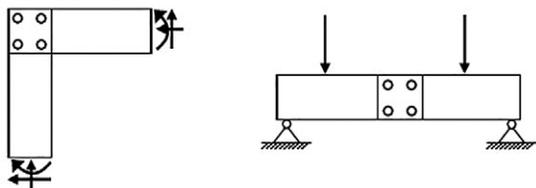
Схема приложения нагрузки при испытании на изгиб [1]
